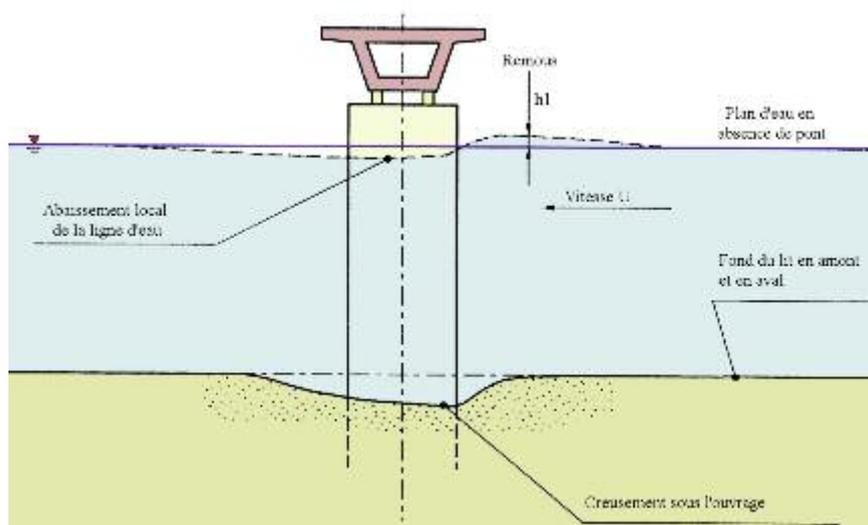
ressaut hydraulique au franchissement d'un ouvrage
